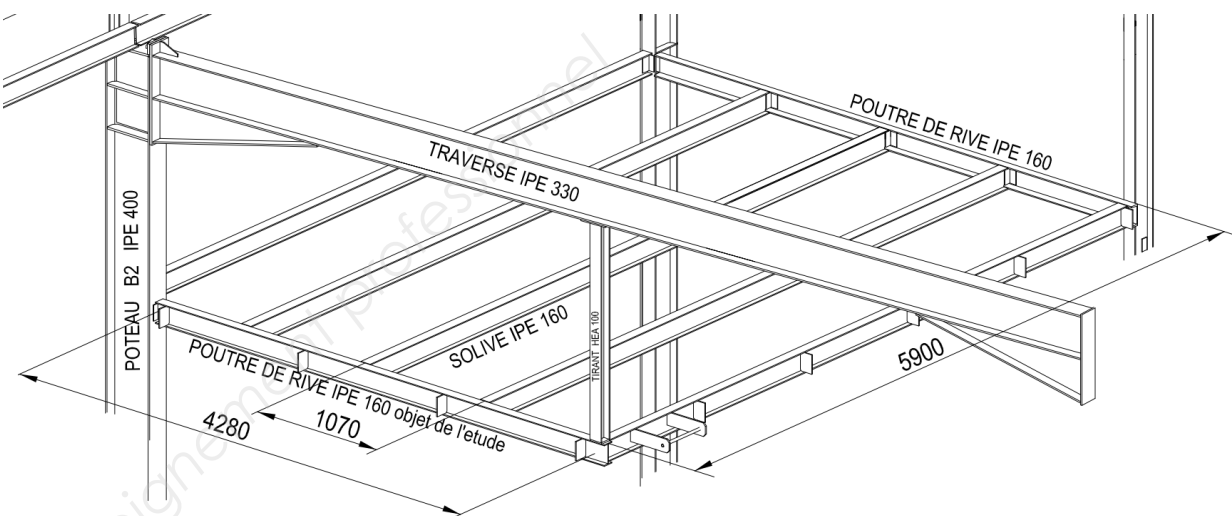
Vue de détail de la poutraison de la mezzanine supportant le plancher en cailleboti avec au premier plan la poutre de rive objet de l’étude. Elle est rattachée au poteau et à la traverse de la file 2.
